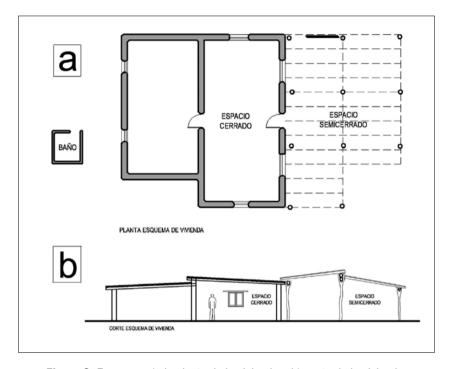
Esquema a) de planta de la vivienda y b) corte de la vivienda.
